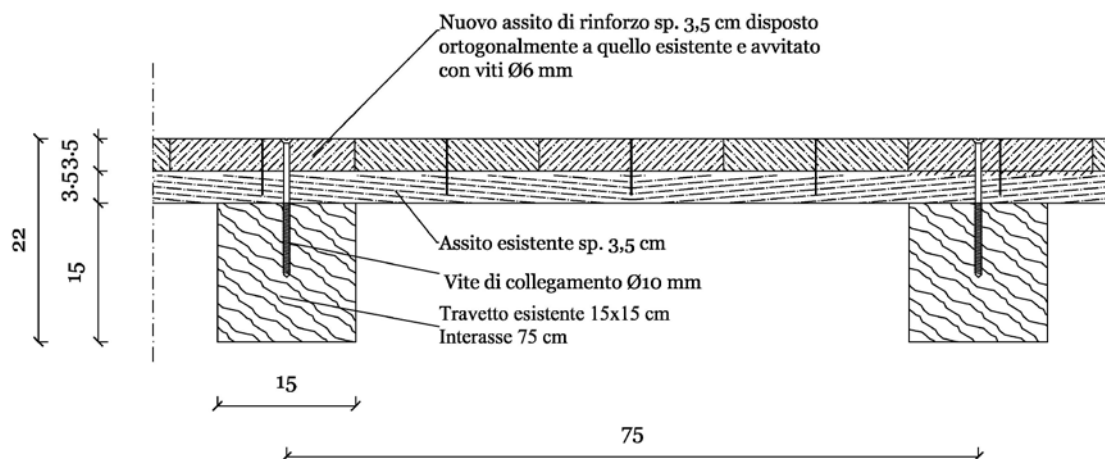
Schema solaio stanza 20.1 – Progetto ing. Jurina
